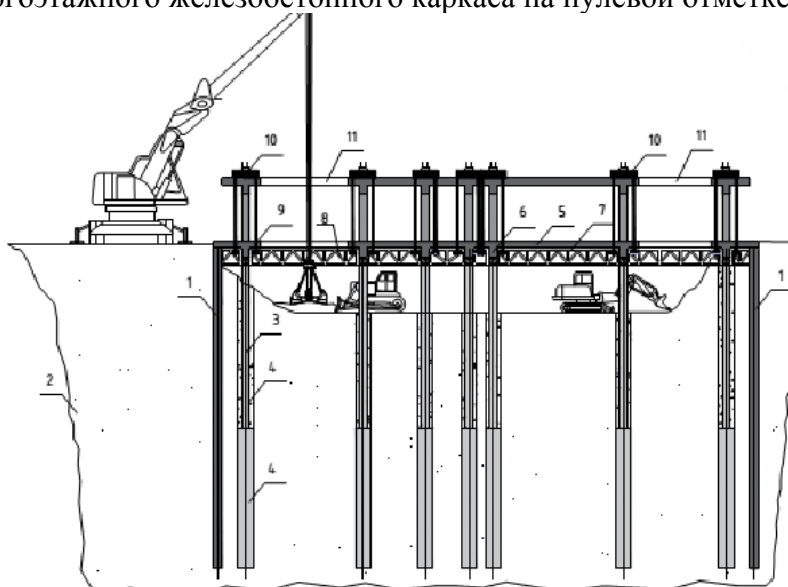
Технологическая схема разработки и выемки грунта в пространстве будущего верхнего этажа подземной части здания
